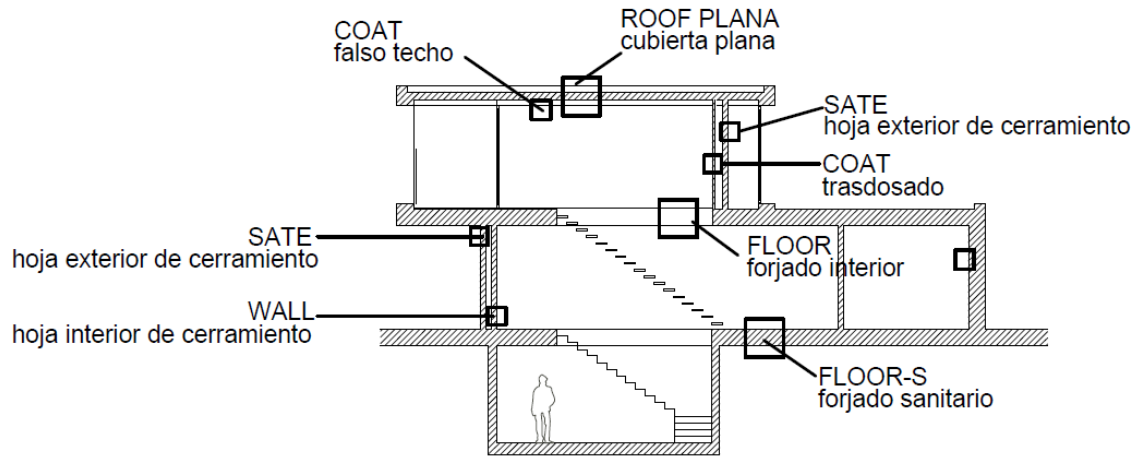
Disposición del sistema ThermoChip con paneles SATE, WALL, ROOF PLANA, FLOOR, FLOOR-S y revestimiento interior COAT.
